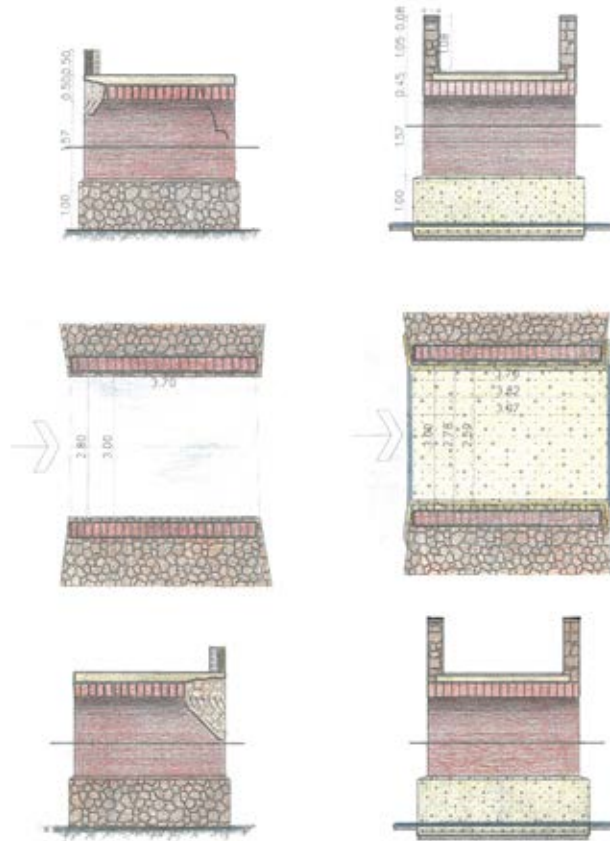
Arriba: Plantas y secciones del puente de las Pilas estado inicial y restaurado. Abajo: Plantas y detalles del puente de las Pilas restaurado en 2018.
